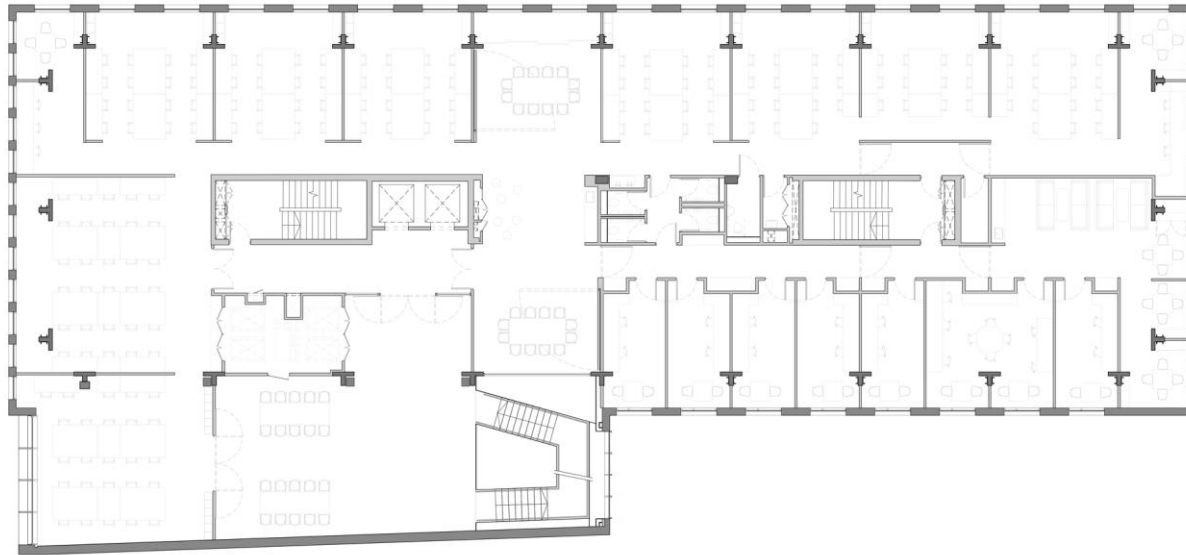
Plan eerste verdieping (Hawkins/Brown).
